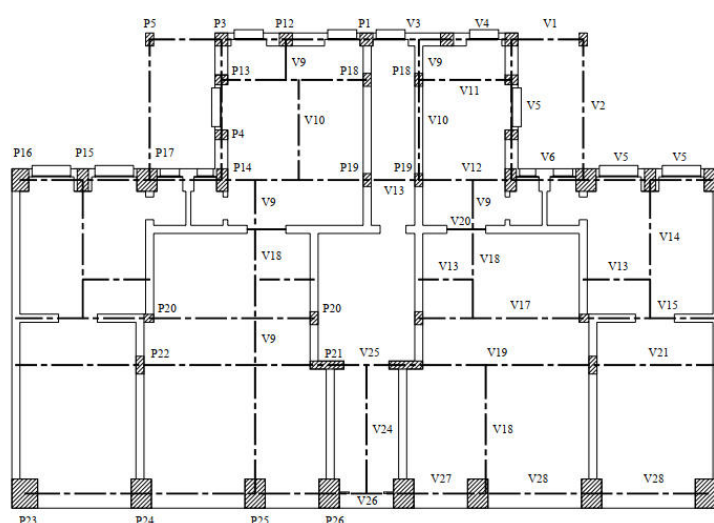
Planta de estrutural do piso térreo do edifício existente em estudo (Lamego, 2014)
